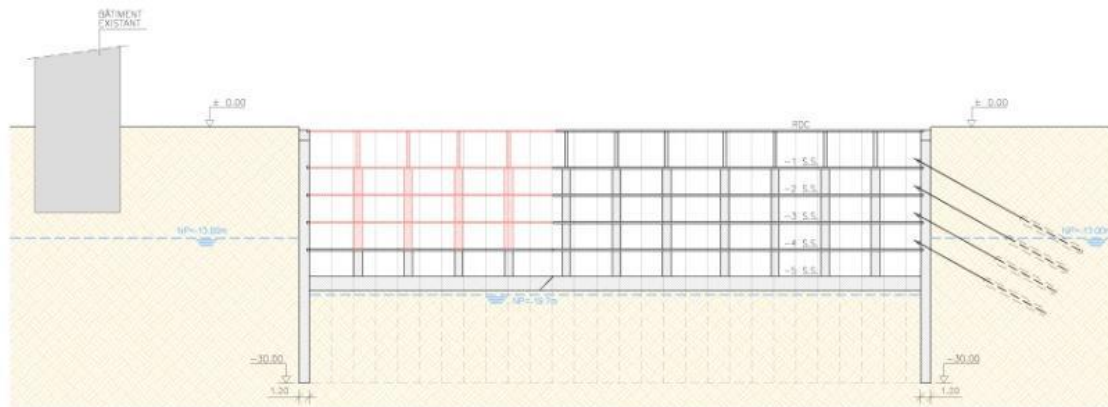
Fase constructiva 32, 33, 34 i 35.
